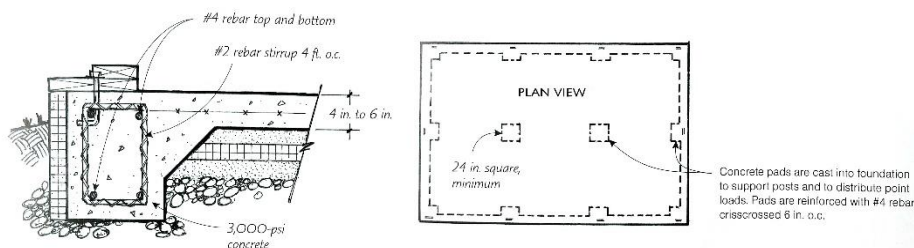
Laje sobre o terreno, típica da solução "timber frame" (Benson, 1977).
